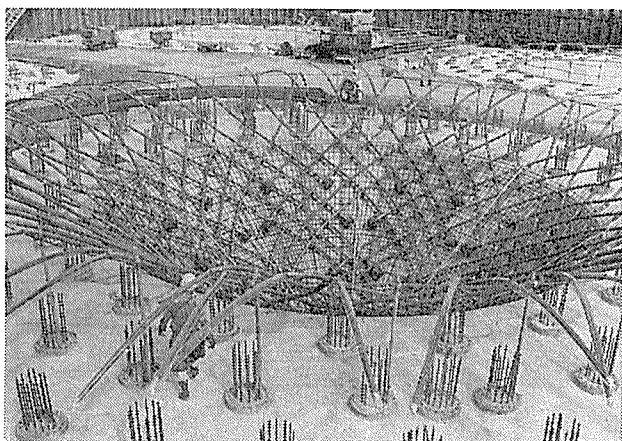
下部円錐 PC 鋼材 (ヘリカル) 配置工事 (リング基礎タイプ)
